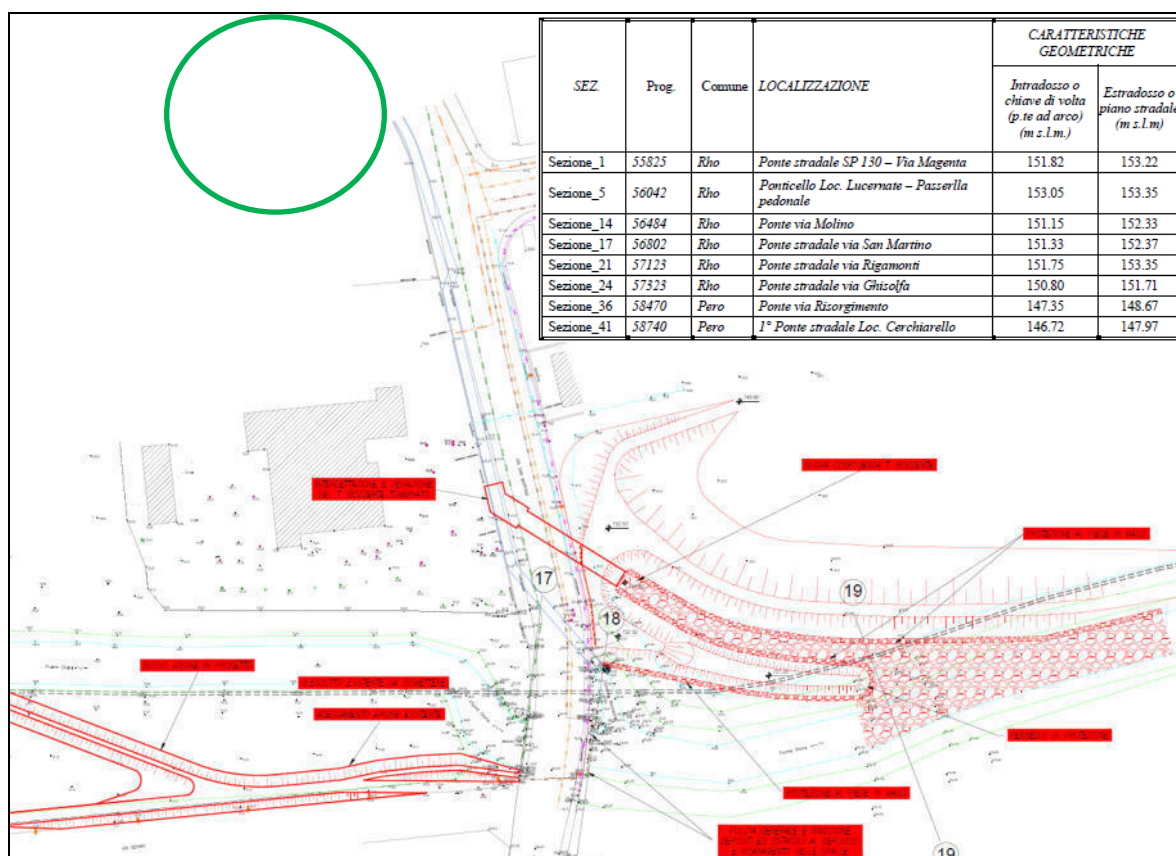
Planimetria opere in progetto (tavola 4) estratta dal Progetto Esecutivo - interventi di riordino idraulico e riqualificazione del Fiume Olona nel tratto urbano Rho (Lucernate) - Pero. Individuazione area di intervento (cerchio verde) e della sezione di riferimento 17M.
